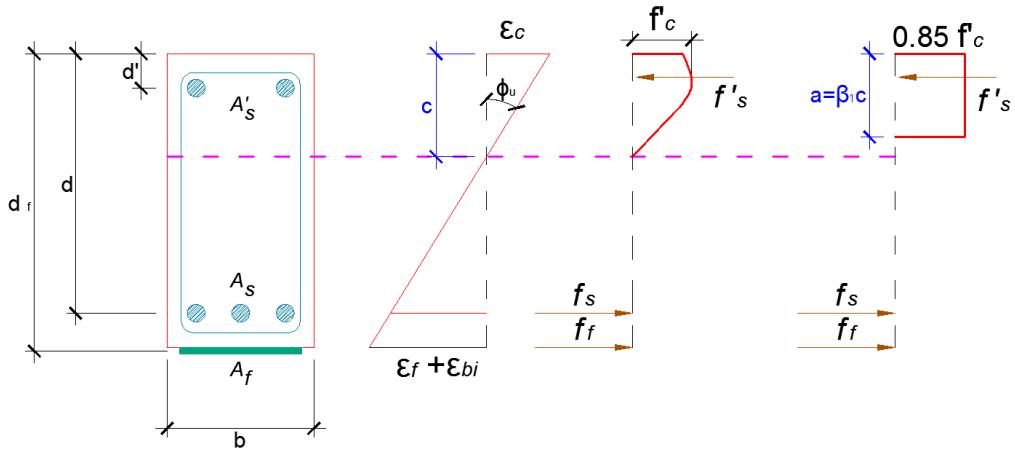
Viga de concreto armado externamente reforzada con FRP en estado último por flexión.
